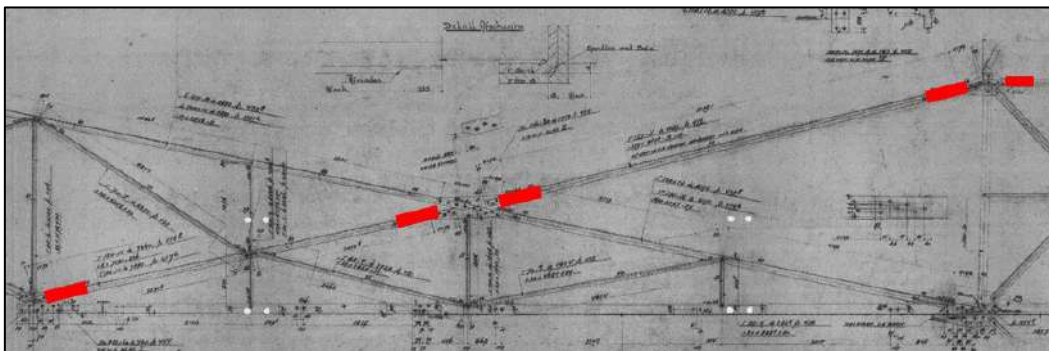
Aanpassingen aan mastlichaam. Voor volledig overzicht zie Appendix E
